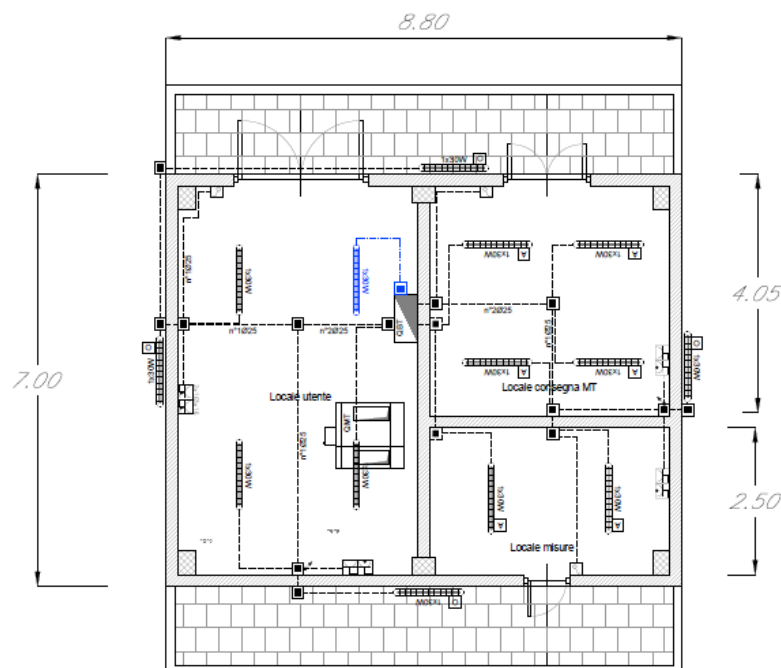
Pianta - Locale tipico consegna energia (FA00, FA01-A)
